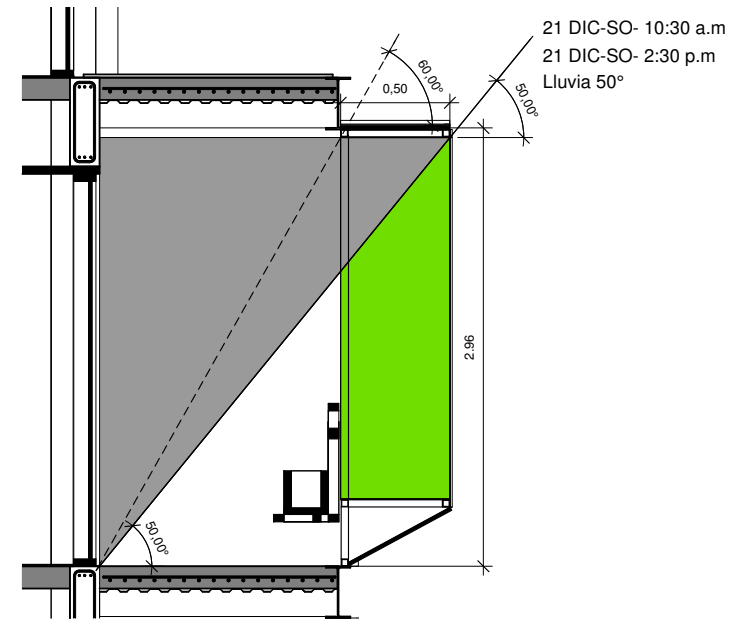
Diagrama Protección climática vetanas periscopicas fachadas Norte-Sur. Fuente propia.
